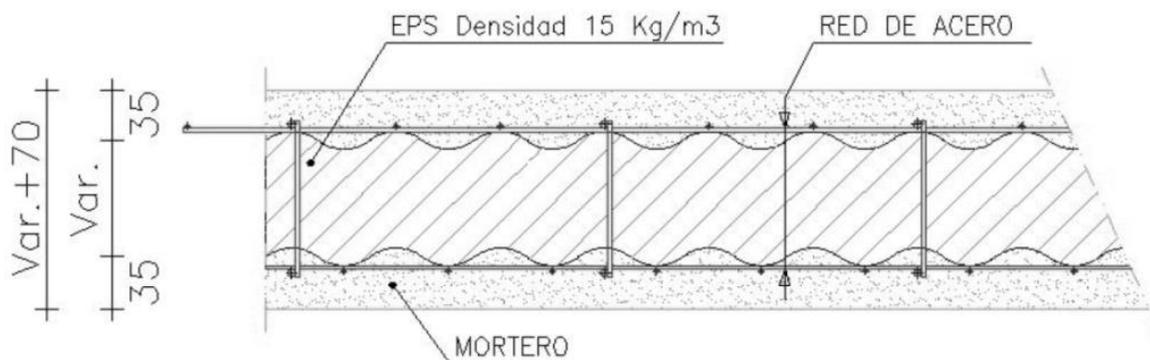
Tipología general de los paneles estructurales para cerramiento de muros.
